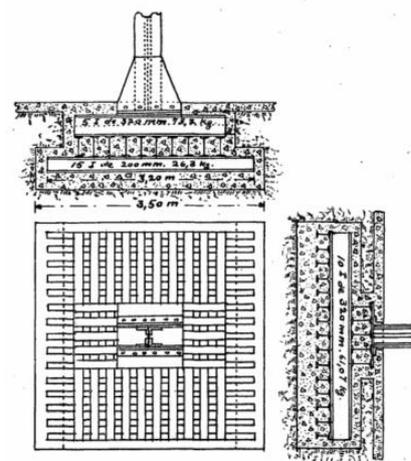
Losa de hormigón armado con ensanchamiento doble en la base (Fernández, 1934)
